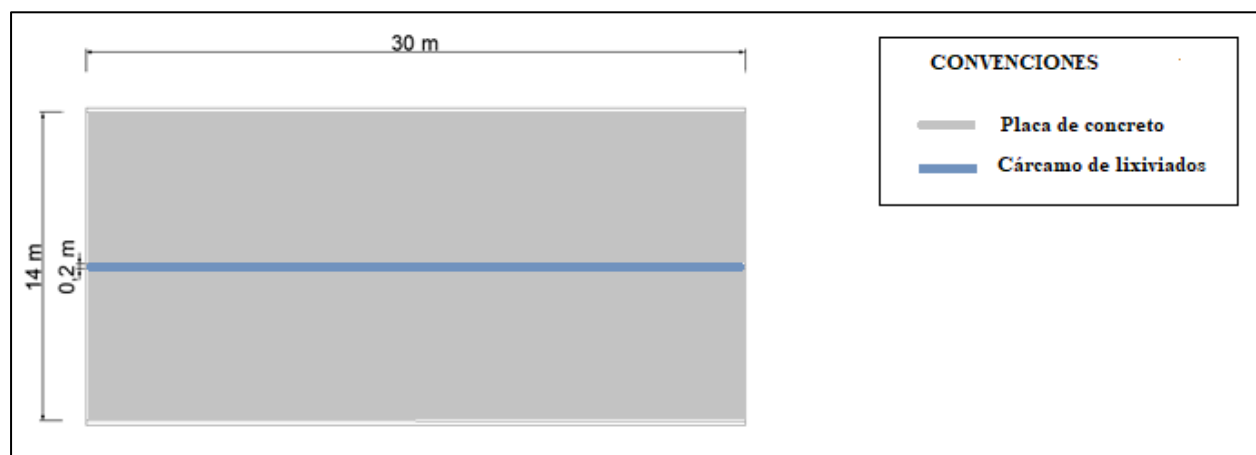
Placa de concreto y Cárcamo de lixiviados.
